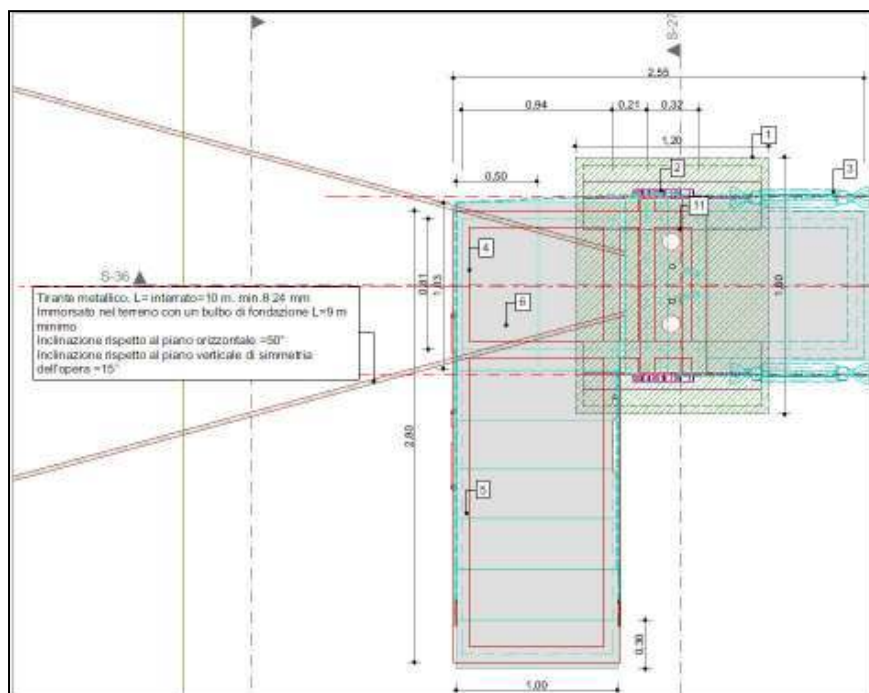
Planimetria indicativa della posizione dei tiranti di ancoraggio
